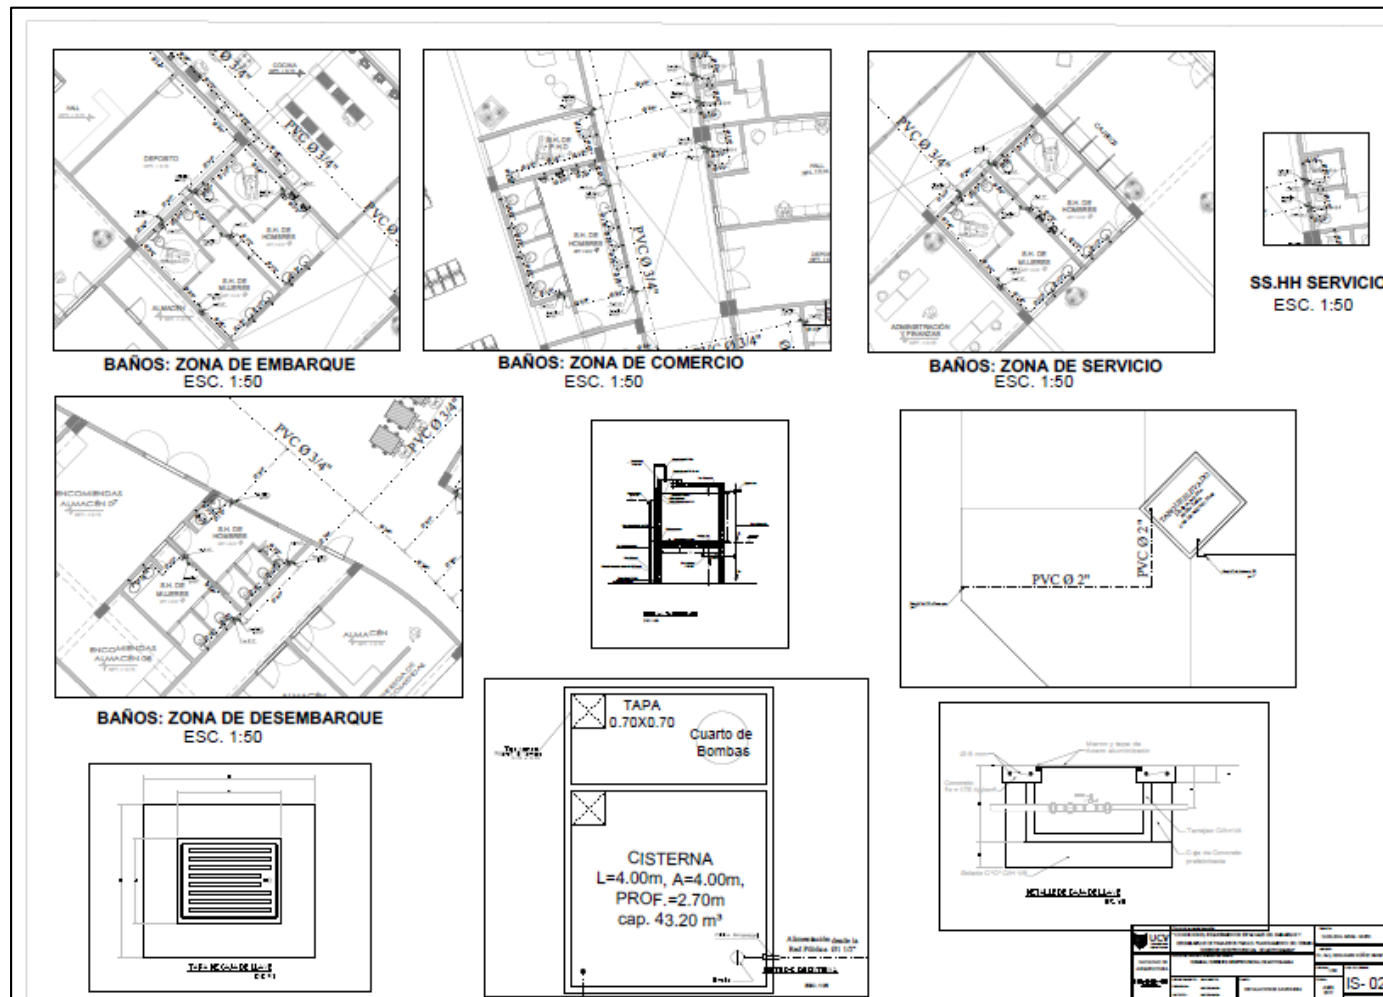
Plano instalaciones agua(detalles), Fuente: Elaboración propia.
